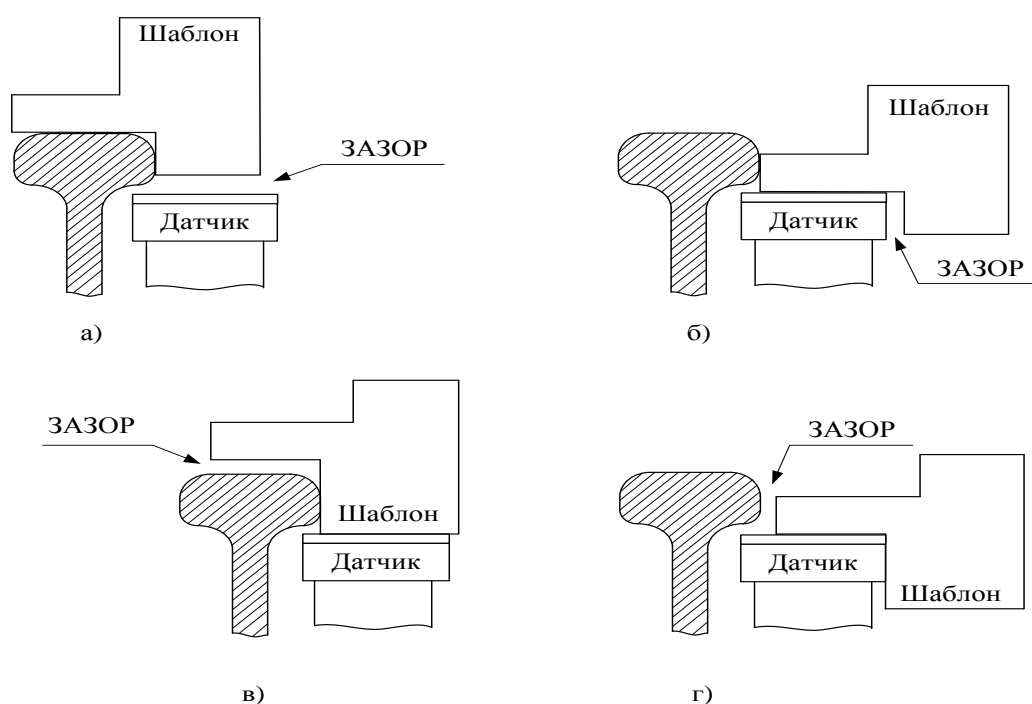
Проверка габаритов установки путевого датчика относительно рельса (а, в – вертикальный габарит; б, г – горизонтальный габарит)
